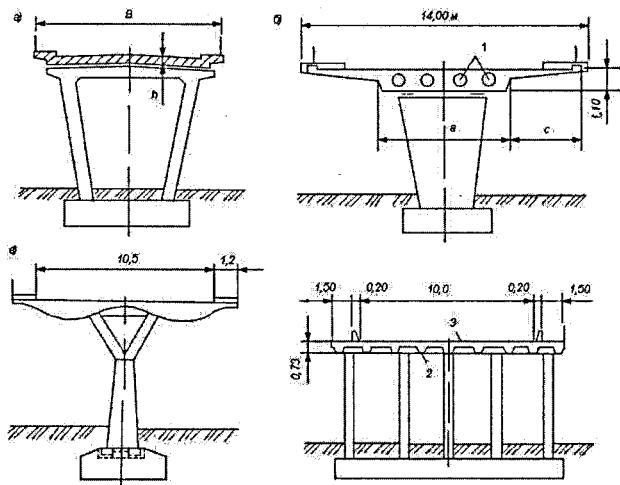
Поперечні перерізи плитних залізобетонних естакад і шляхопроводів: 1 – порожнечі; 2 – збірний елемент – брус; 3 – монолітна плита проїжджої частини
